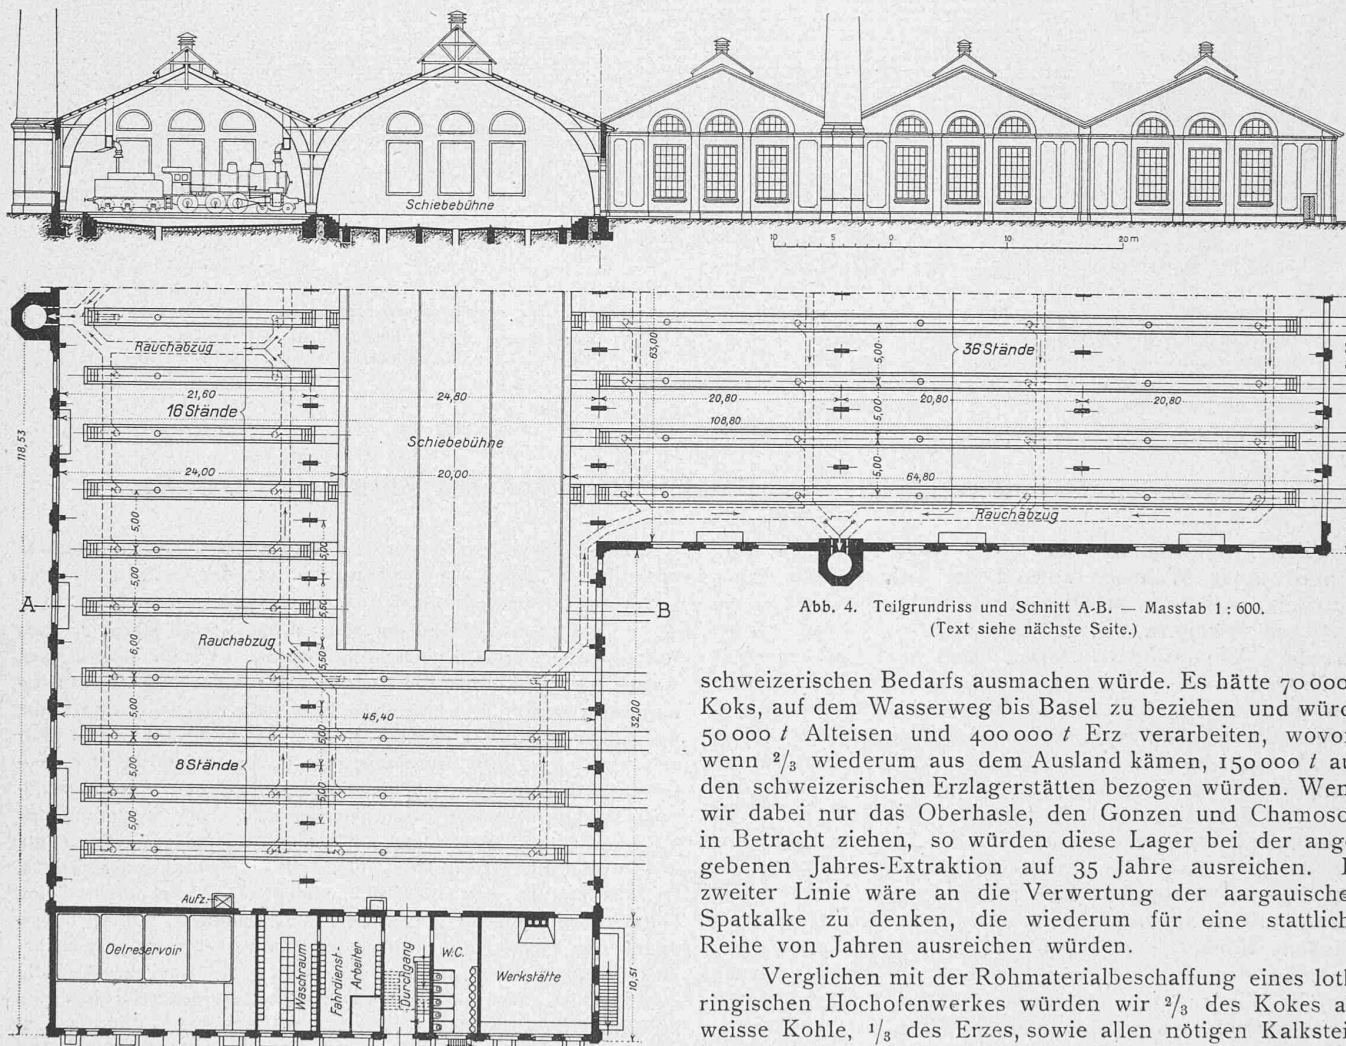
Teilgrundriss und Schnitt A-B. — Masstab 1 : 600.
